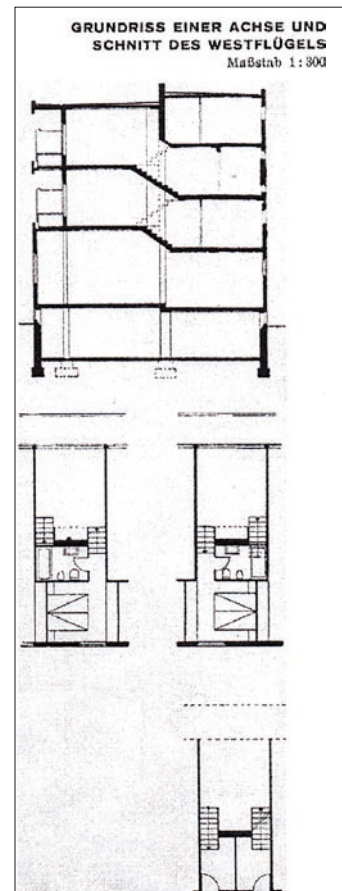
Grundriss einer Achse und Schnitt des Westflügels.
